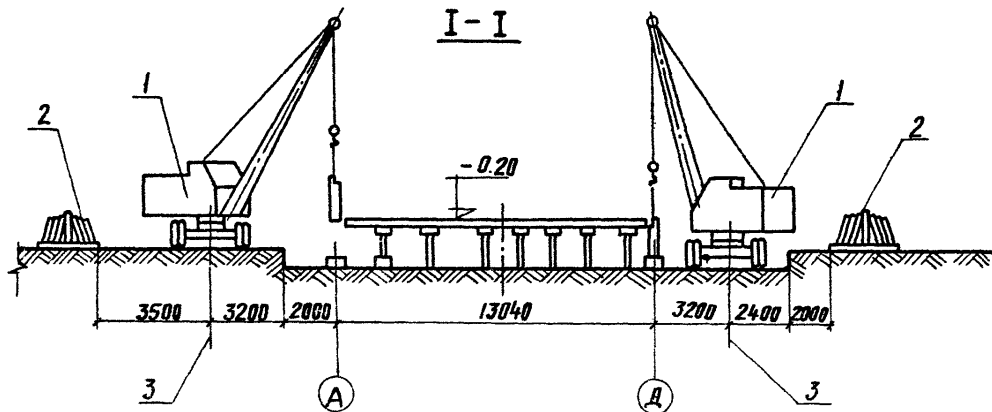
Монтаж поперечных панелей: 1-пневмоколенный кран К-161;
